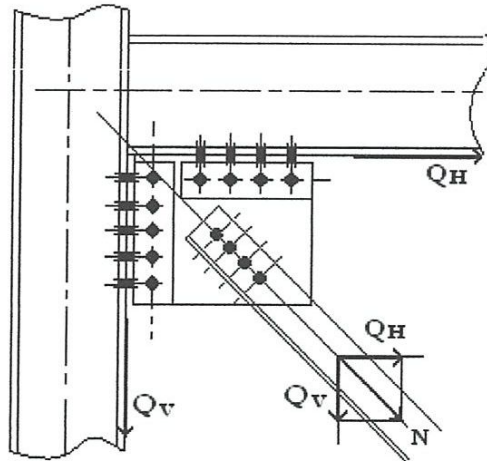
la ligne d'épure de la diagonale est épurée sur l'intersection des plans d'attache.
